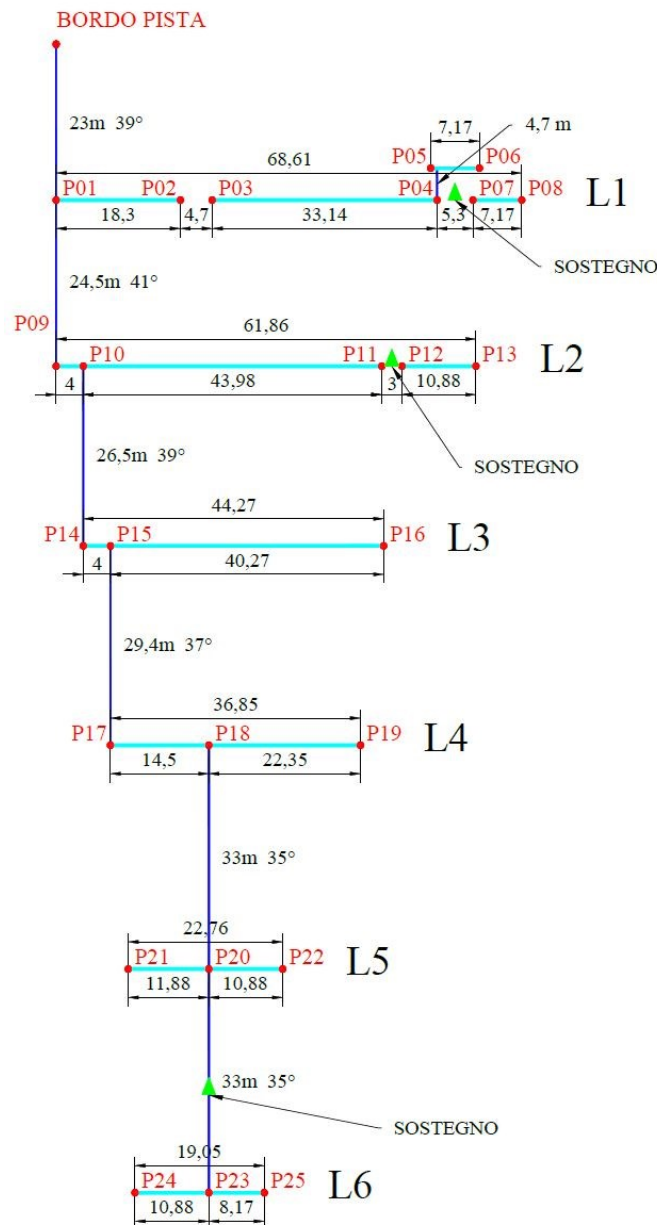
PLANIMETRIA DI TRACCIAMENTO
